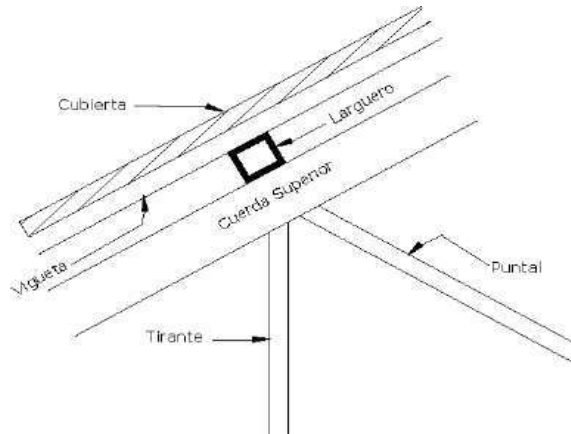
Techo formado por larguero, viguetas y cubierta.
